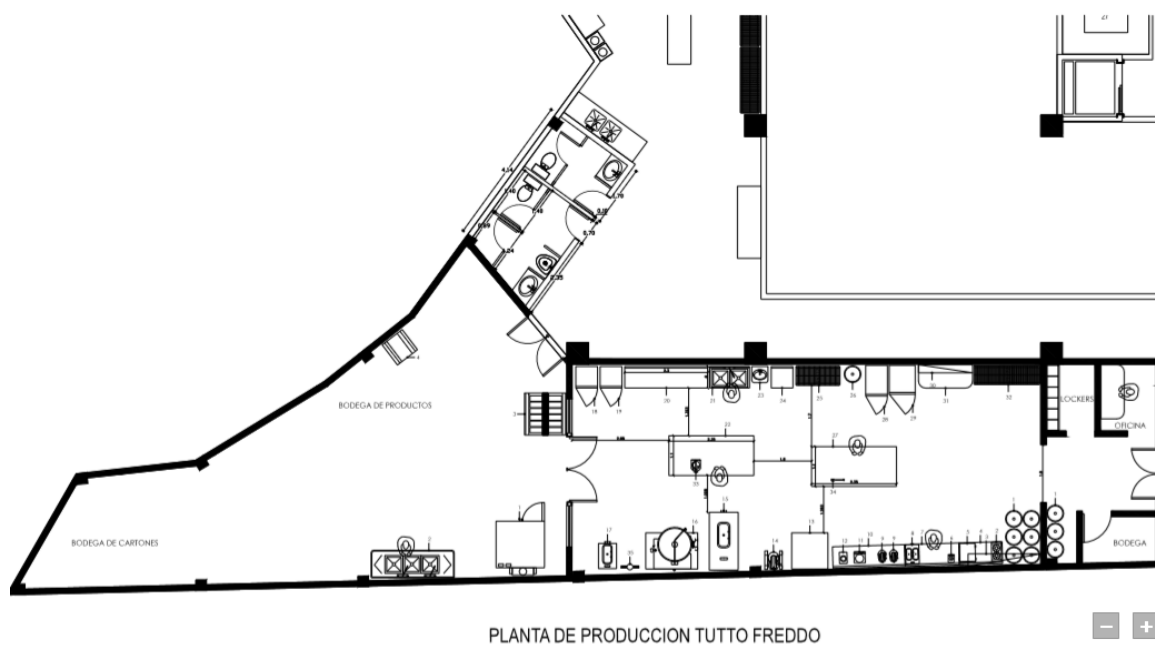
Distribución de la planta de producción. Plano arquitectónico. De “Planta de producción Tutto Freddo”, por I. Coellar, 2015. Reproducido con permiso.
